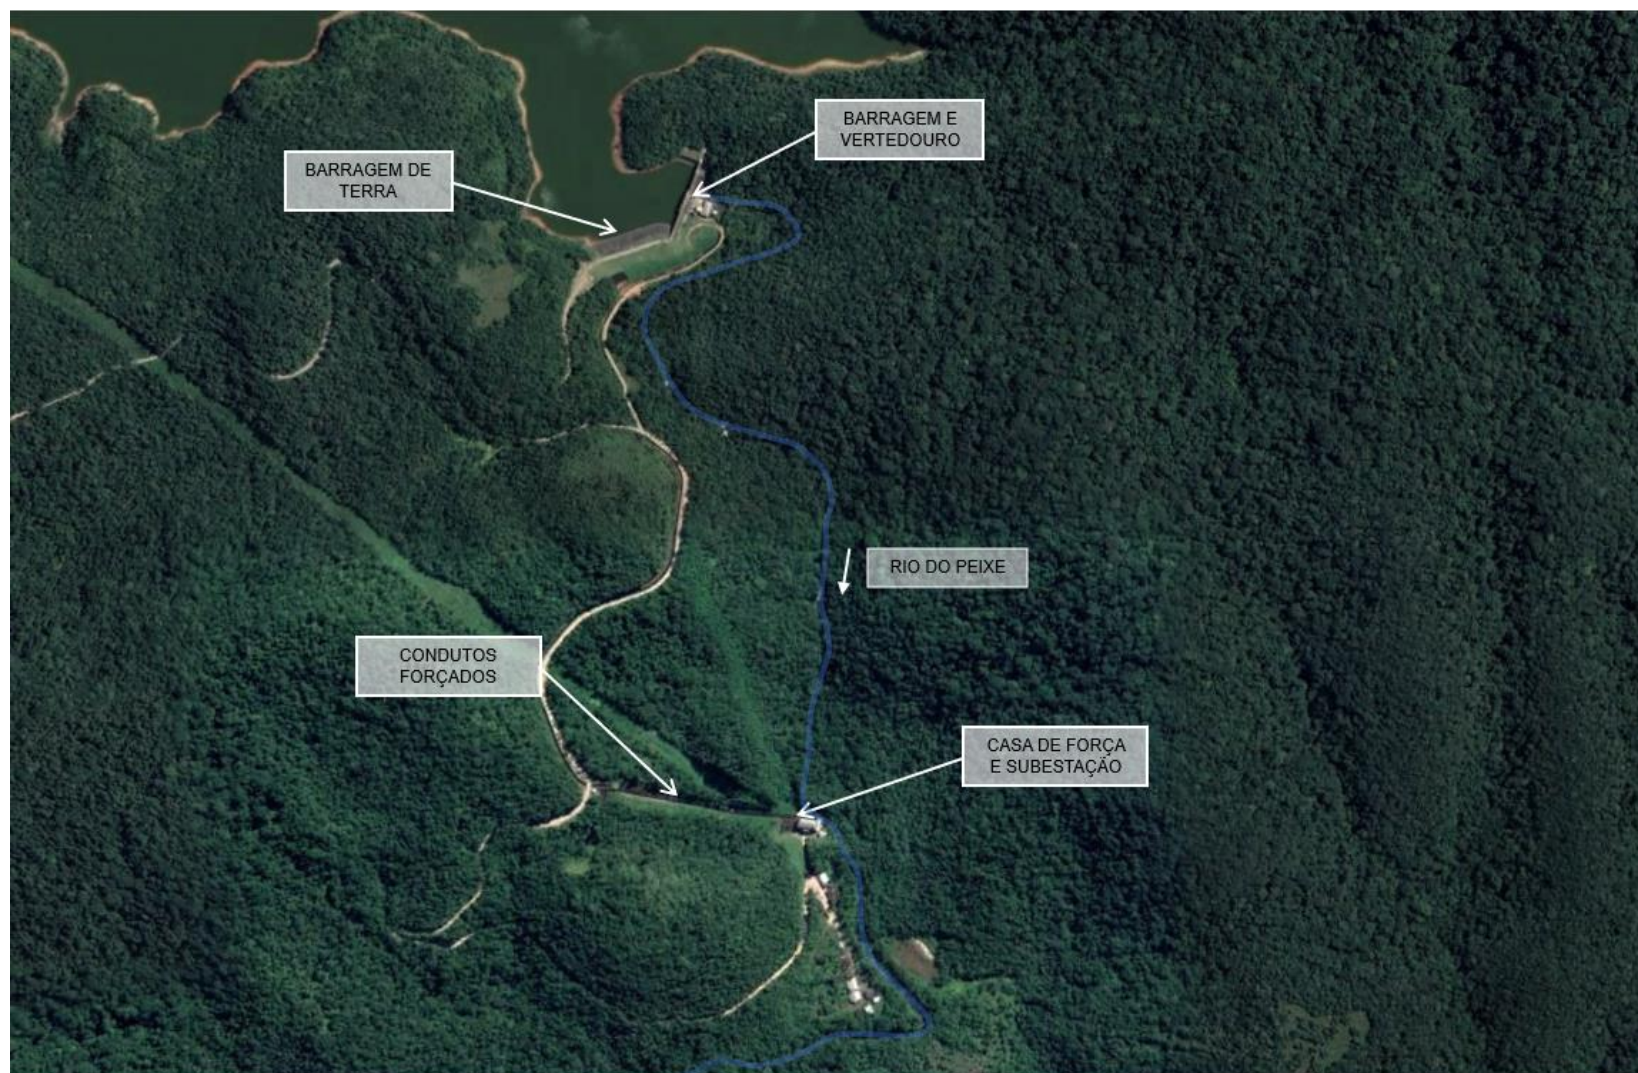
PCH Jurupará – Arranjo Geral - Planta.
